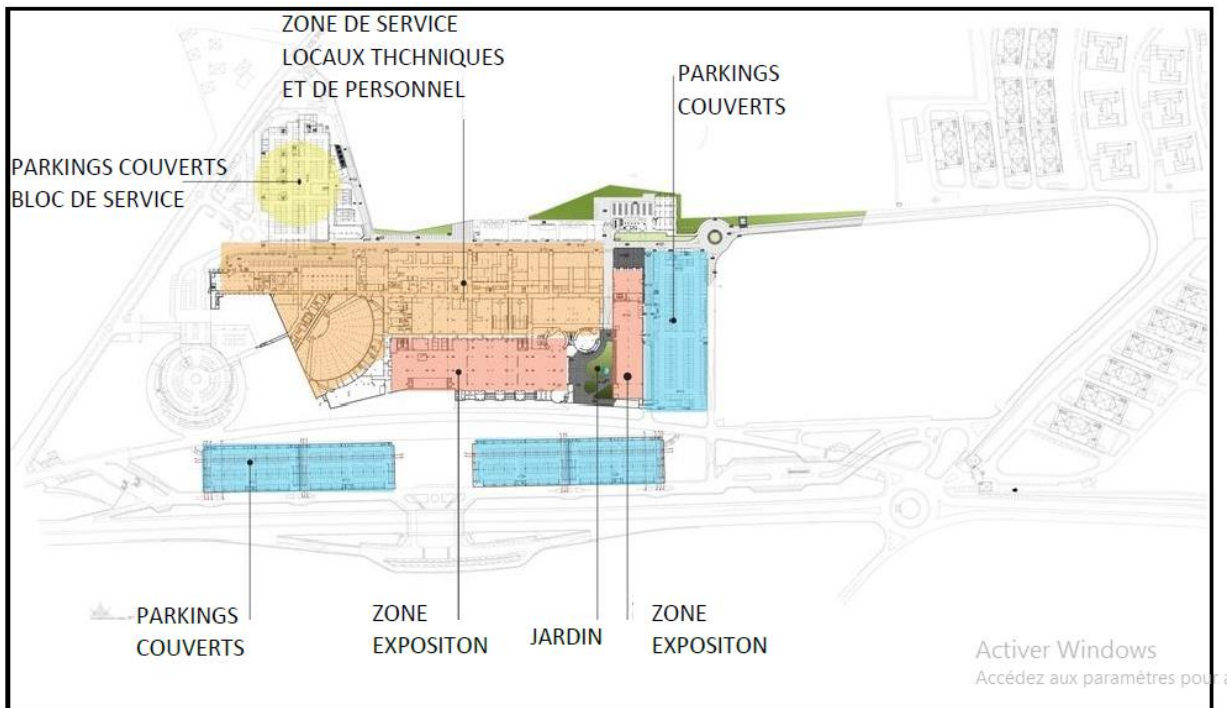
Plan de sous-sol plan de CIC d'Alger
